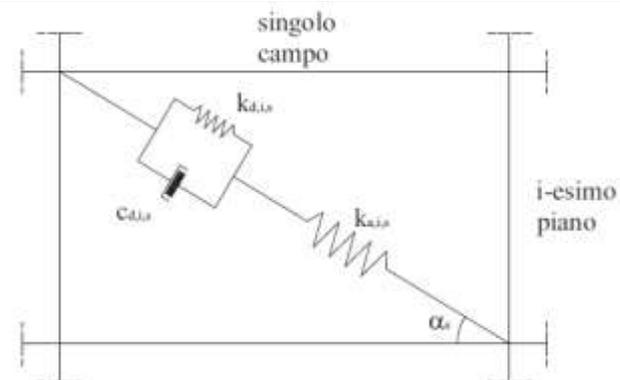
Rigidezza risultante del telaio rinforzato con sistema dissipativo
